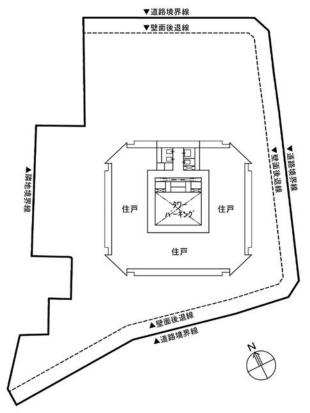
(5) 各階平面図 (4~30 階、基準階)
